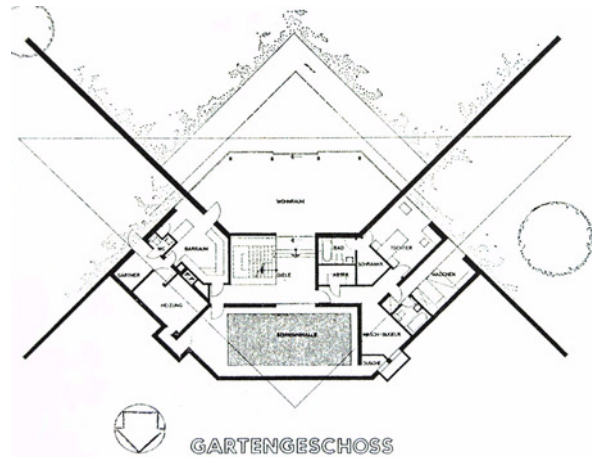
Wohnhaus in Bredenev, Grundriss Gartengeschoss, M 1:300
